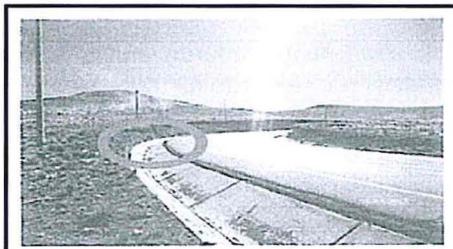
Vista del lugar donde sufrió la volcadura el camión de placa CGX-722 / B6Y-983 Altura Panamericana Sur Km 199.500 Lagunillas. Distrito Santa Lucía, Provincia Lampa, Departamento Puno. Toma de foto 16/07/17 para su apreciación.
